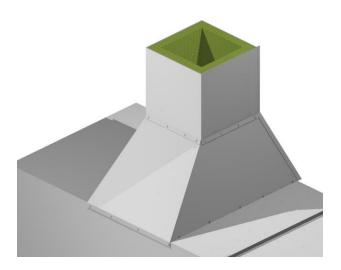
Branche de conduit conique et verticale <sup>2</sup>
